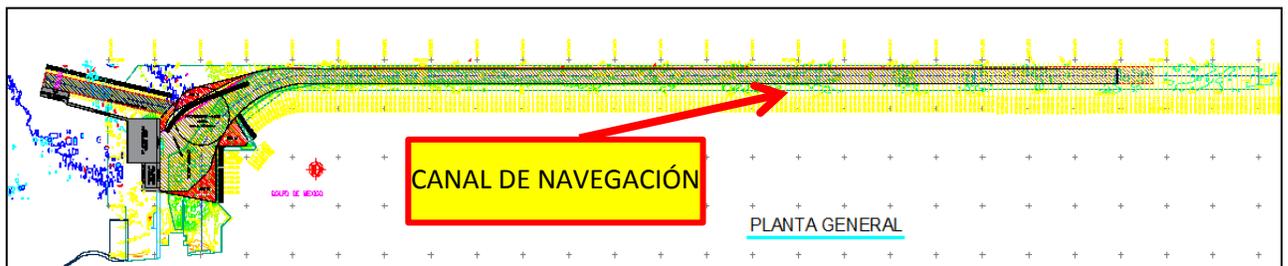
Ilustración de la planta general donde se observa el canal de navegación donde se realizarán las actividades de dragado.
